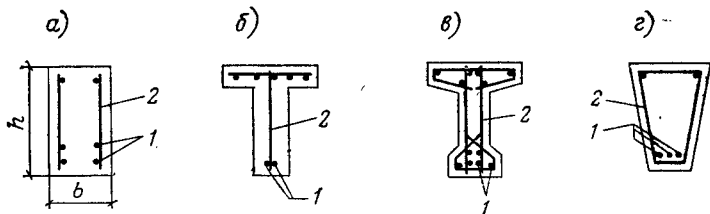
Формы поперечного сечения балок и схемы армирования
